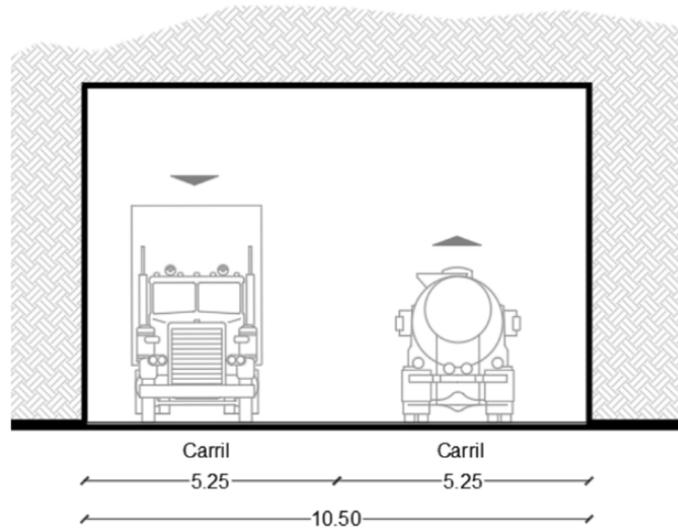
Distribución metros carretera camino a Tecualtitán/ Sección E-E'
